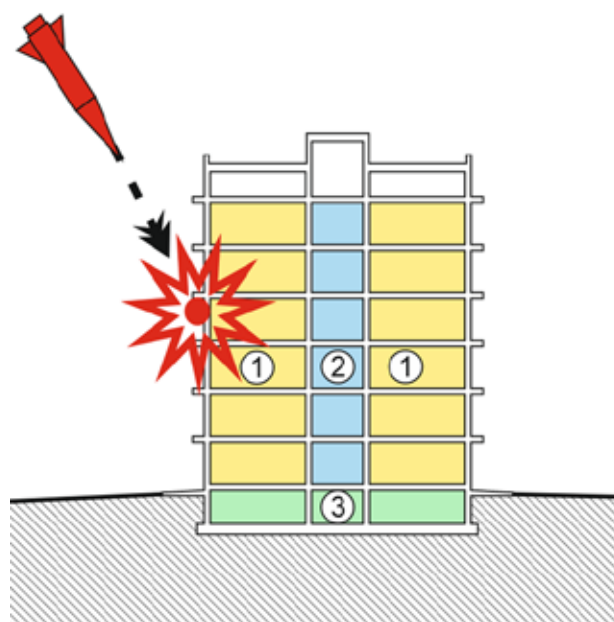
Схема руйнування будівлі лікарні зі стандартною об'ємно-планувальною схемою:
